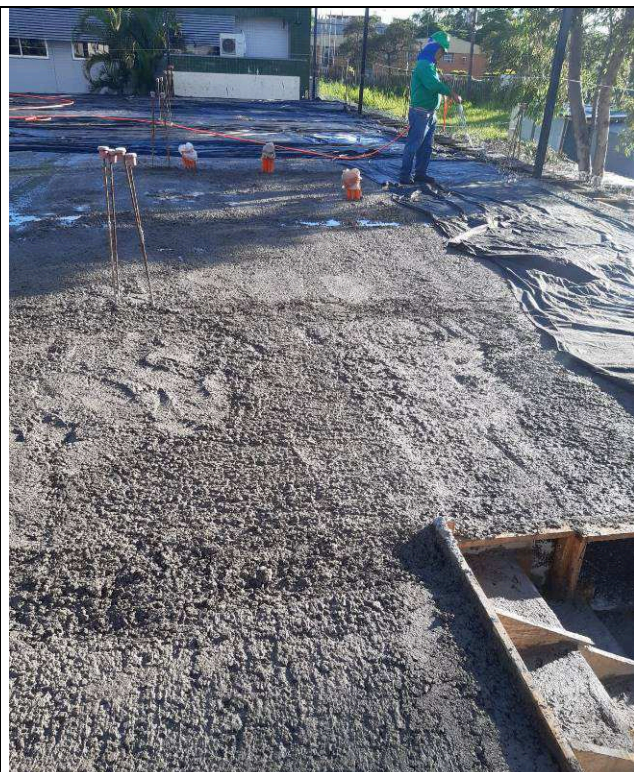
Concretagem – vigas e lajes – 1º Pavimento.
